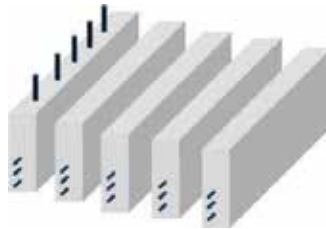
Vigas pretensadas. Fuente: <http://www.arqhys.com/construccion/vigas-pretensadas.html> (2016)
